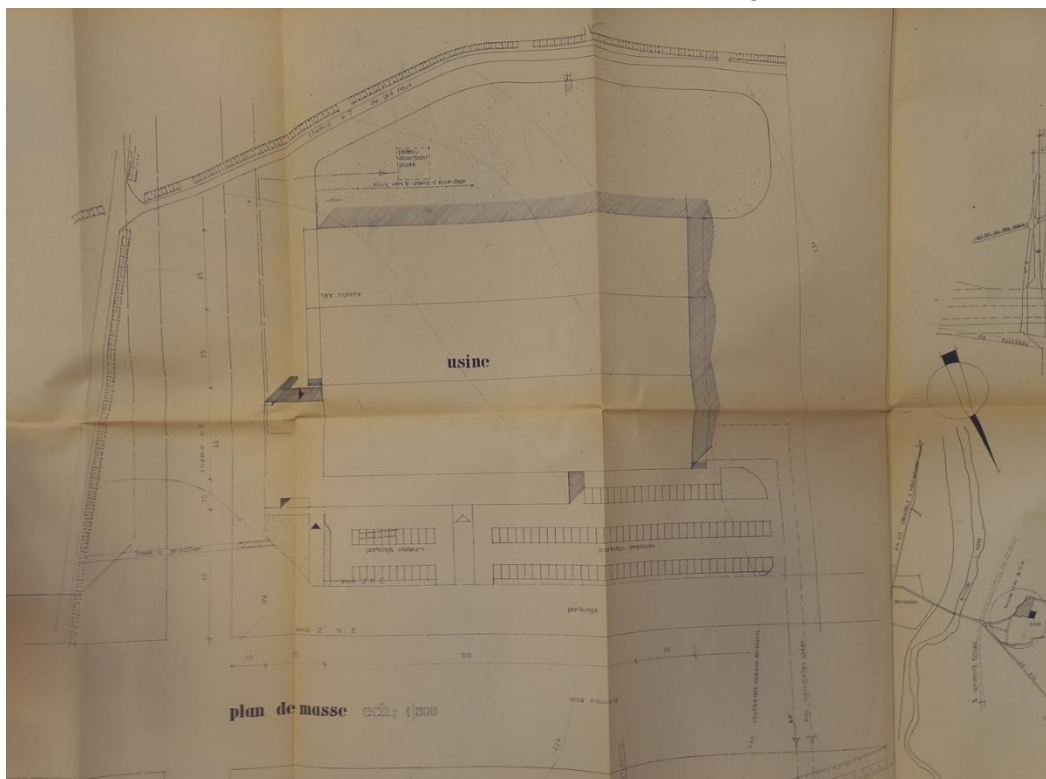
Plan projet de l'usine Teisseire de Crolles en 1967.
